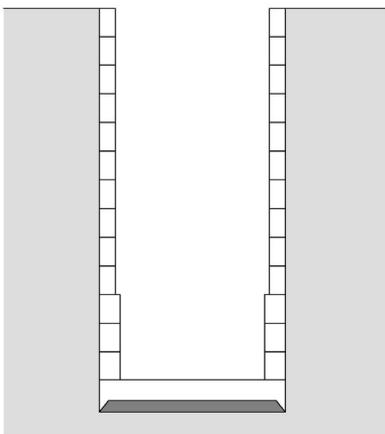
非常口の施工概要 (ケーソン工法の場合)
